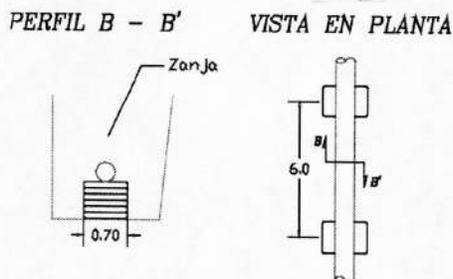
Detalles barreras de sacos en suelo para bajado de tuberías y excavaciones
